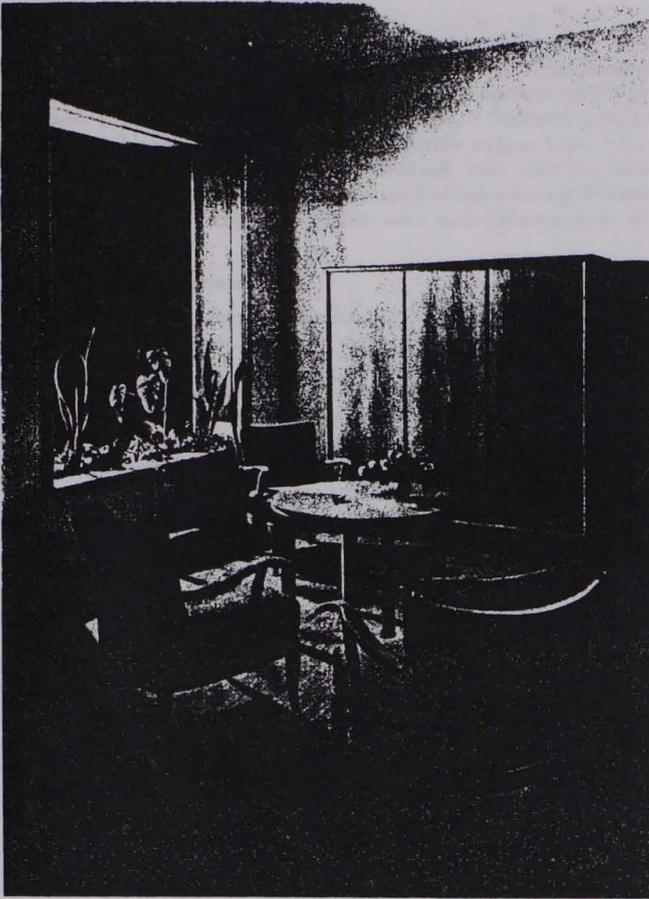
Kleine Halle in der Städt. Frauenklinik in Stuttgart. Arch. Städt. Hochbauamt, Stuttgart
